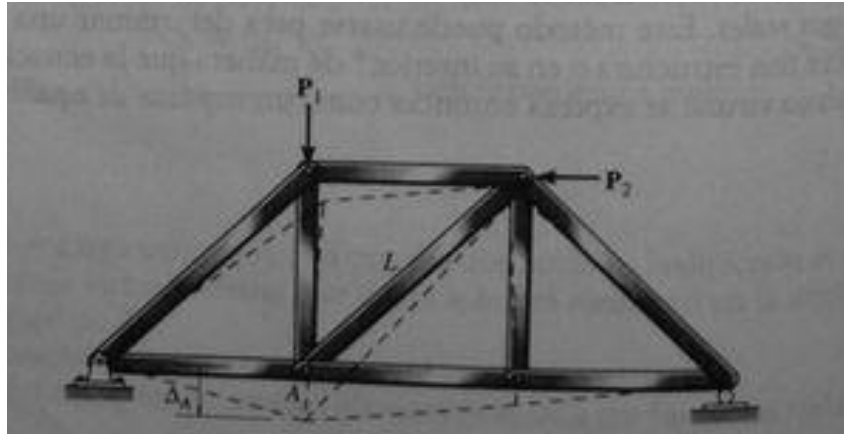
Deformación virtual de una armadura bajo la acción de una carga P (Hibbeler; 1997: 388).
